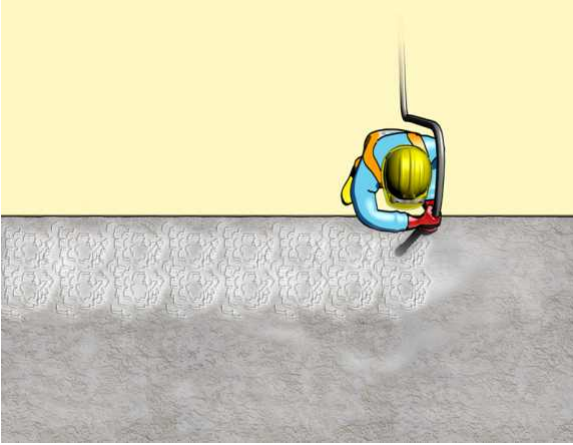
Beton dökümünden önce gerekli güvenlik önlemlerinin sađlanması gerekir.
